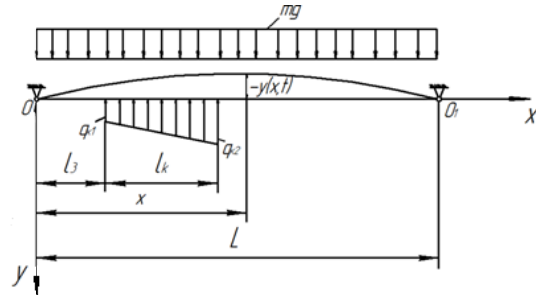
Расчётная схема блока кровли после хрупкого разрушения
